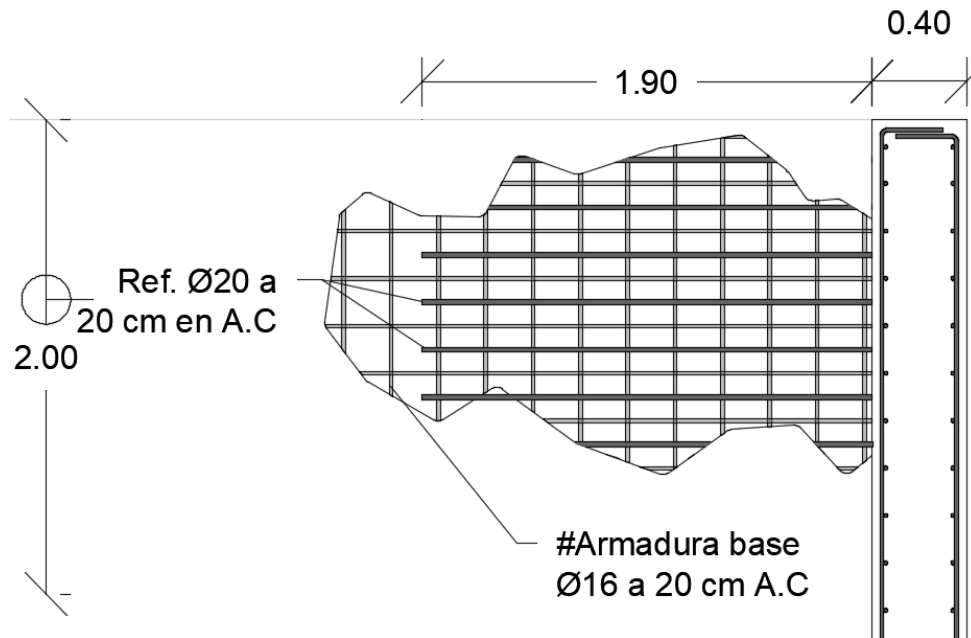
Refuerzo en muro interno 1 exterior (armadura horizontal)
